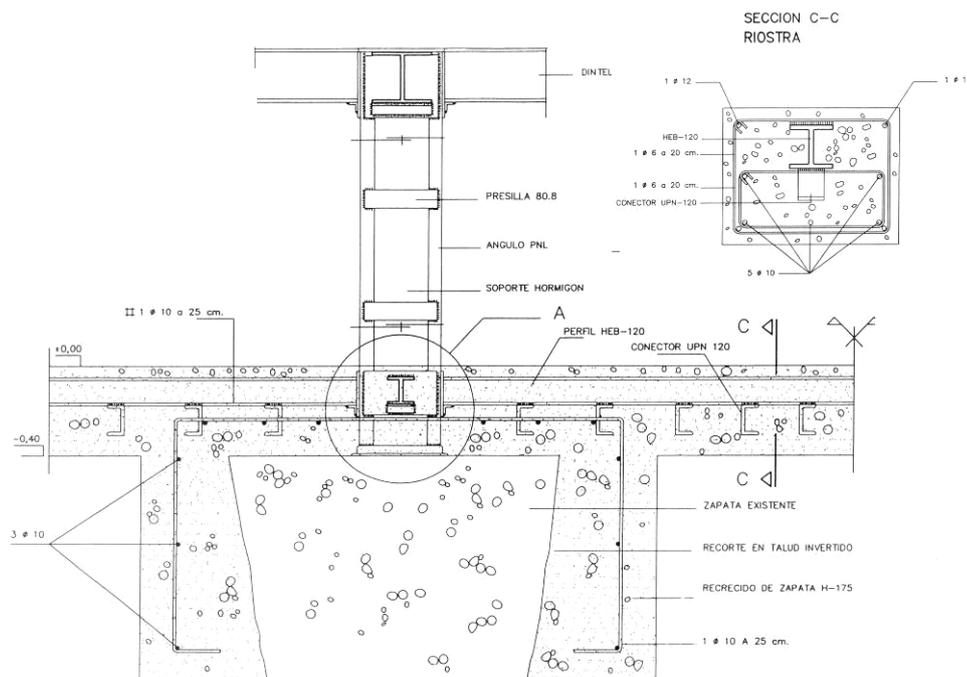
Refuerzo estructural y recalce con disposición de vigas riostras mixtas
